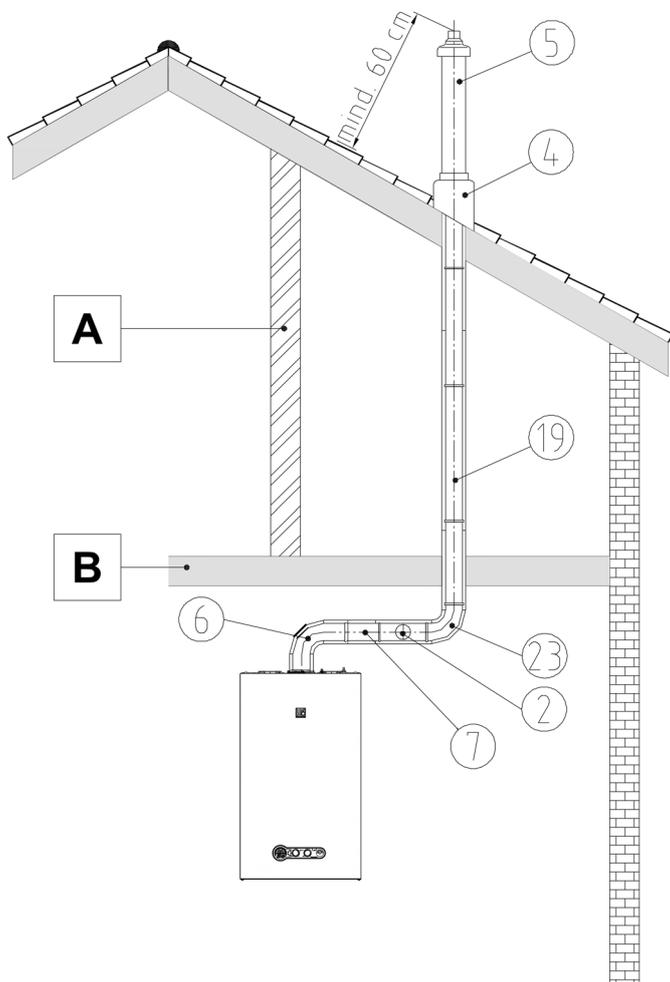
C<sub>33X</sub> Dachheizzentrale mit Luft-Abgas-Rohrsystem senkrecht durch eine Decke und eine Dachhaut
